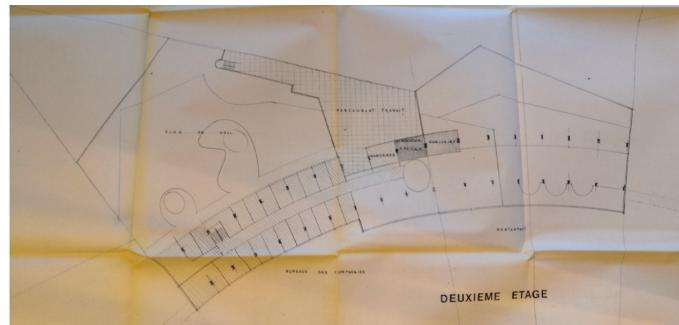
Plan masse des installation, aérogare de Toulouse-Blagnac 2, architectes : Montier, 1973
